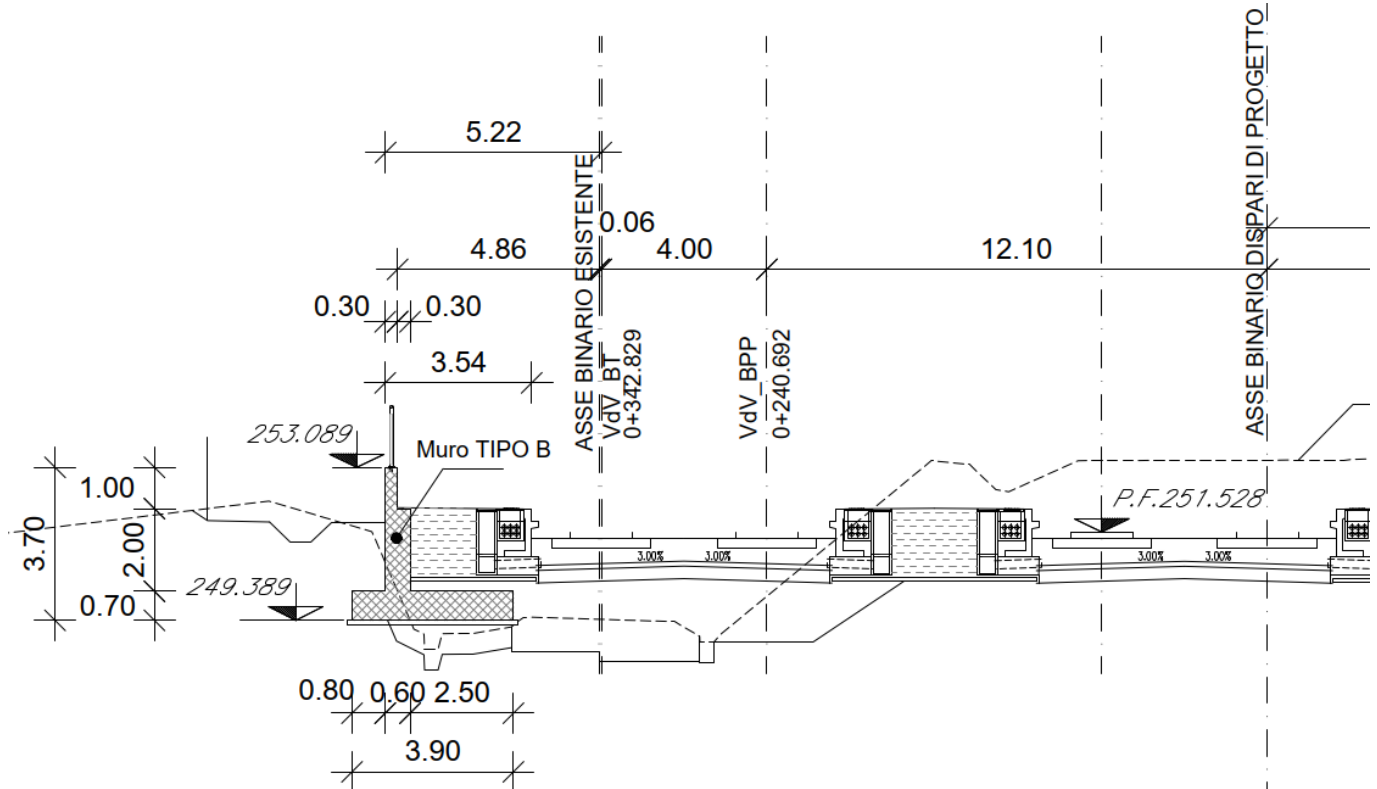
Muro Tipo B – Sezione trasversale tipo H=300 cm
